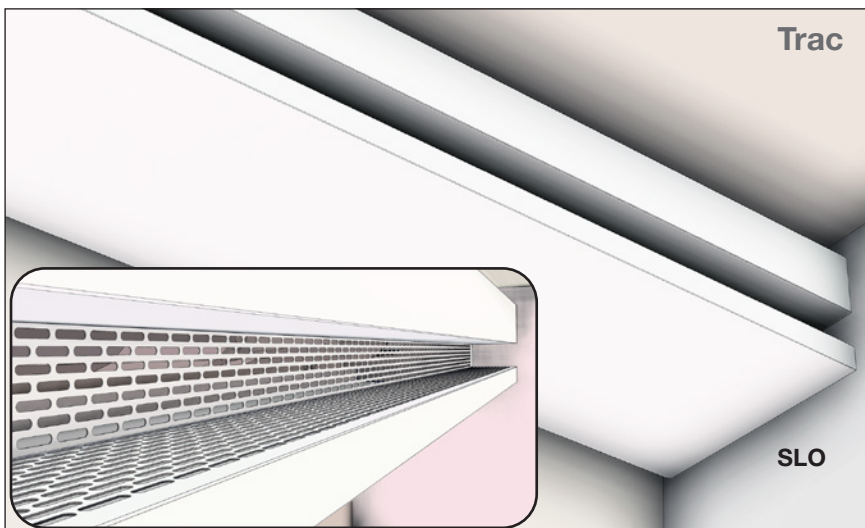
Plafond XD, Trac Designabdeckung mit Perforation SLO. Detailaufnahme eingefügt.
